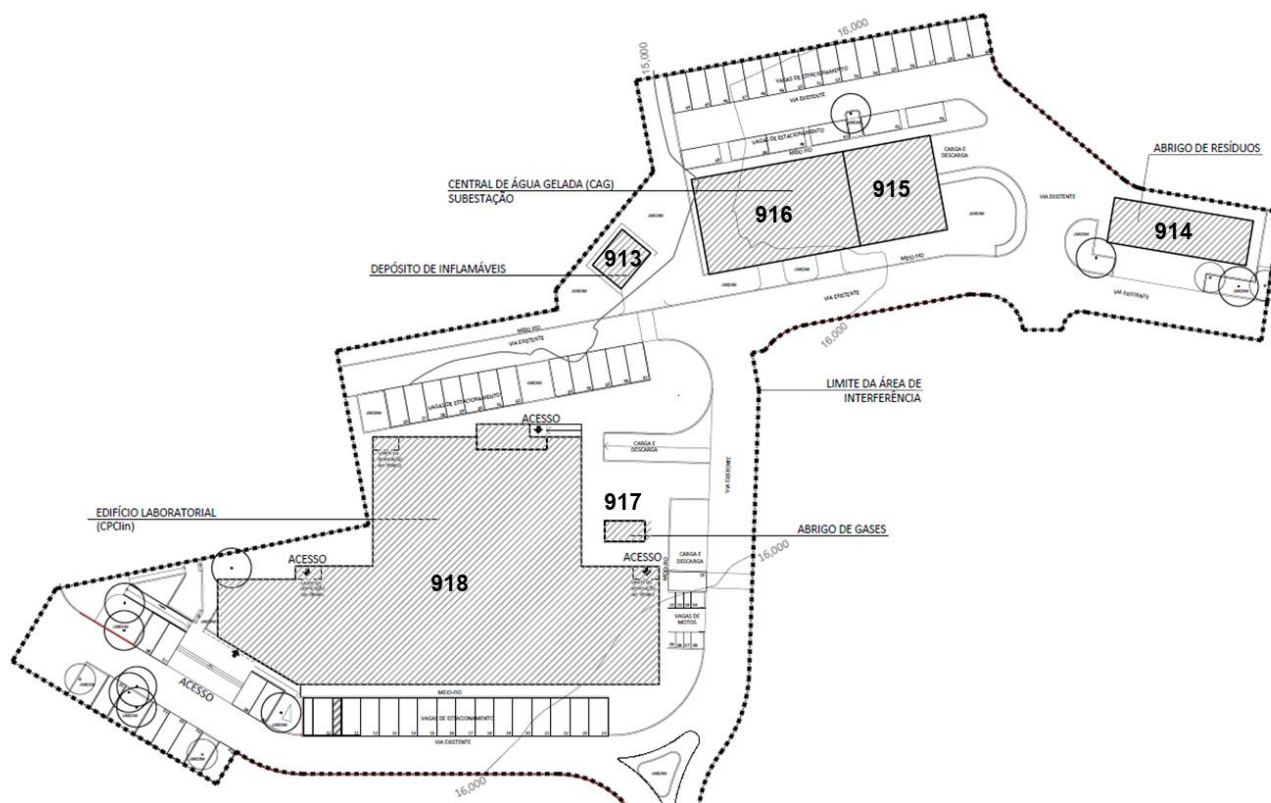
Planta de localização das edificações do INI-CPClin a serem construídas.
